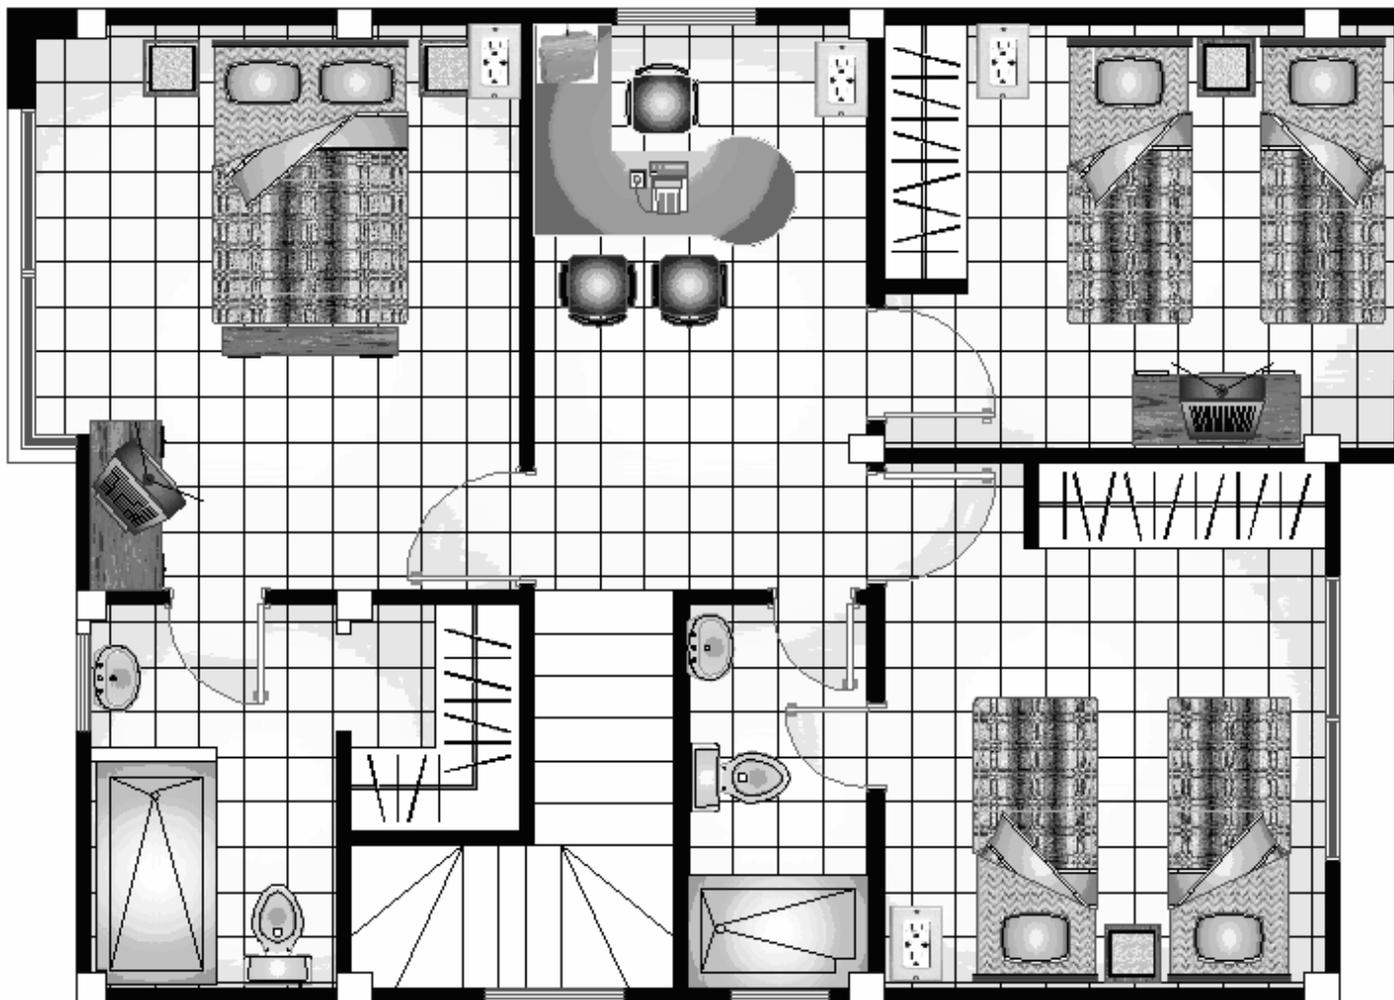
Sistema de Control, Planta Alta, Plano Arquitectónico.
